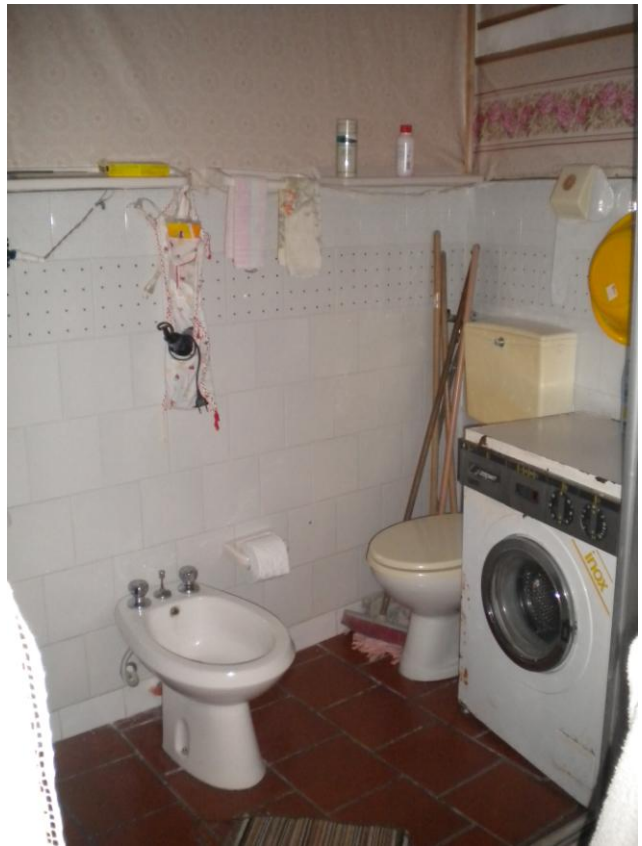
e 17 (Angolo cucina e w.c. con ingresso dalla camera due)
